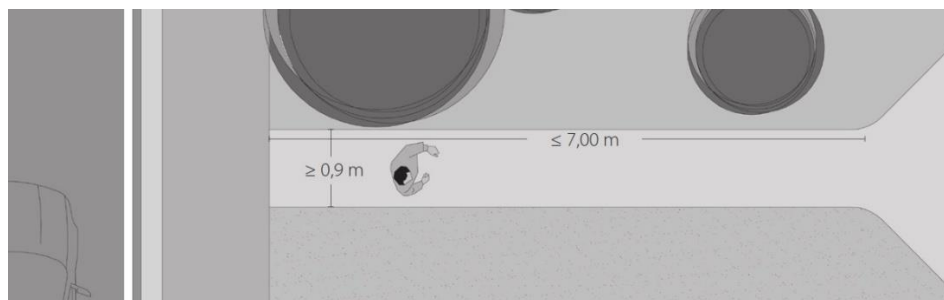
Dimensão da largura do passeio junto a área plantadas [11]
